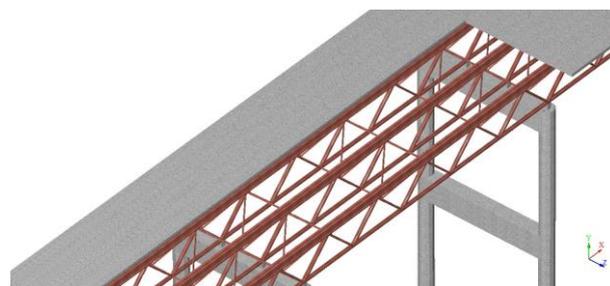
Modelo 3-D del puente. Pilas, Vigas reticuladas y Losa de H°A°.
